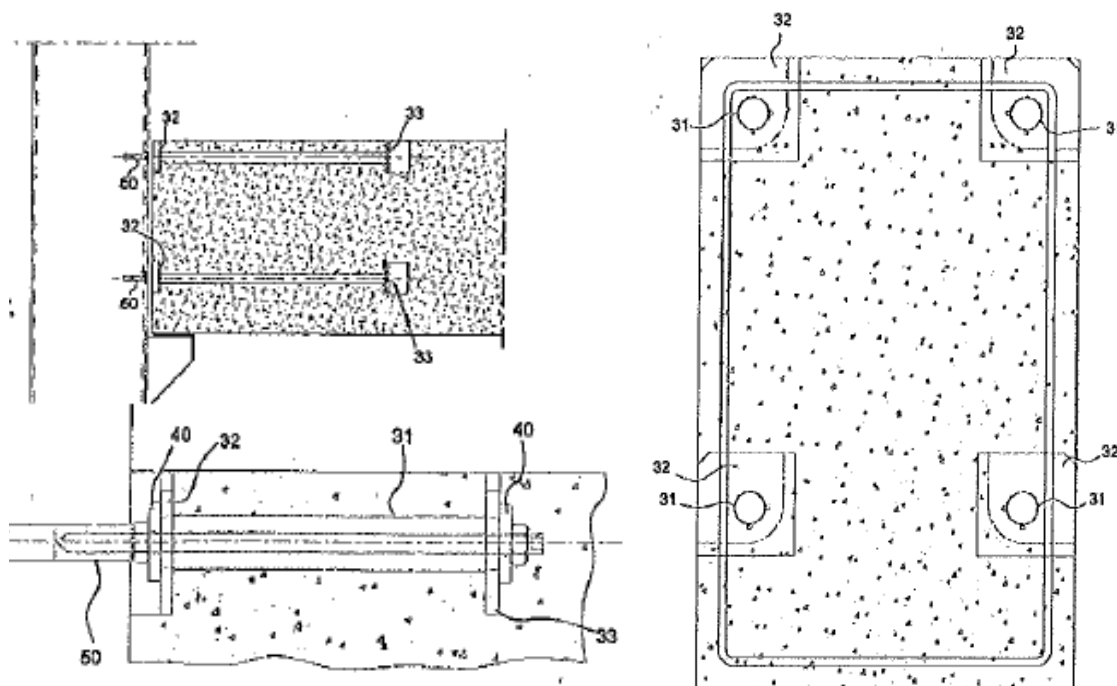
Visione prospettica del sistema di collegamento Locatelli – Sistema progettuale n.15
